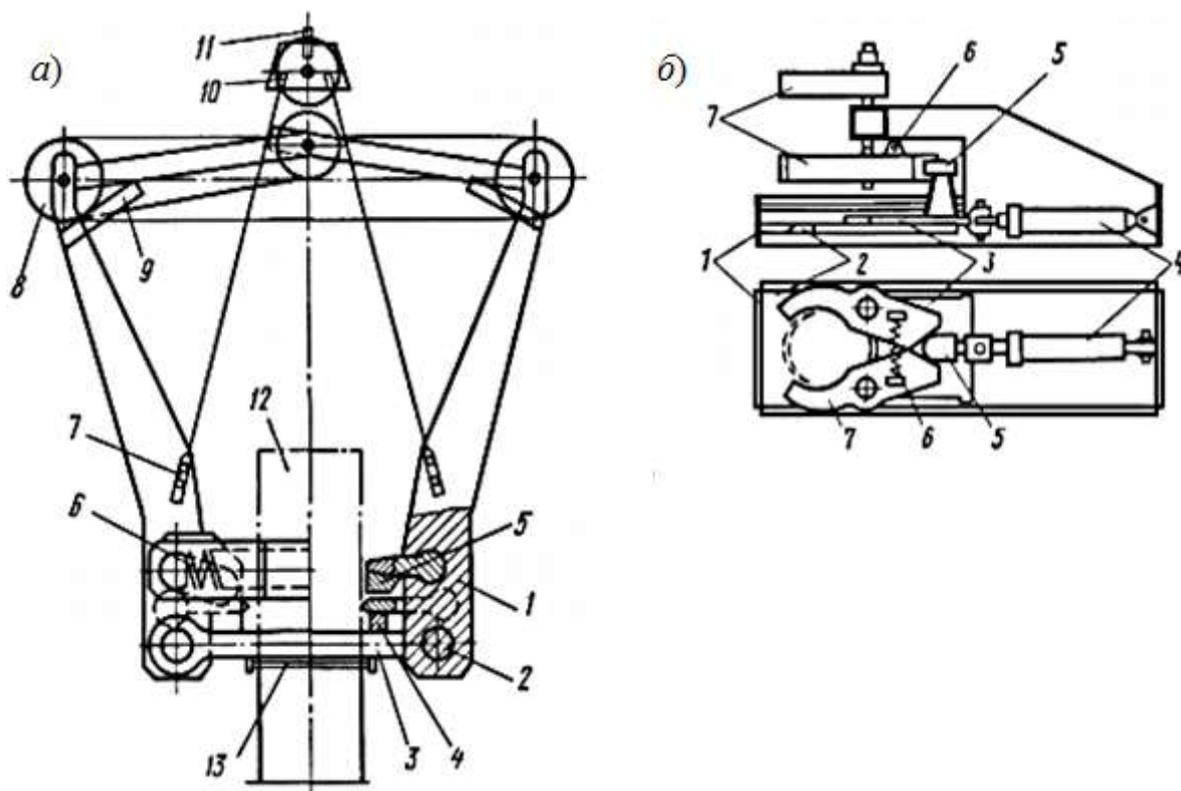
Оборудование для срезки голов свай: *а* – конструкция: 1 – рычаг; 2 – палец; 3 – рама; 4 – нижний нож; 5 – верхний нож; 6 – пружина; 7 – монтажный крючок; 8 – полиспаг; 9 – упор; 10 – петля; 11 – тяговая петля; 12 – свая; 13 – струбцина; *б* – сваерез с захватом: 1 – корпус; 2 – неподвижный нож; 3 – подвижный нож; 4 – гидроцилиндр; 5 – клин; 6 – пружина возврата; 7 – рычаги.
